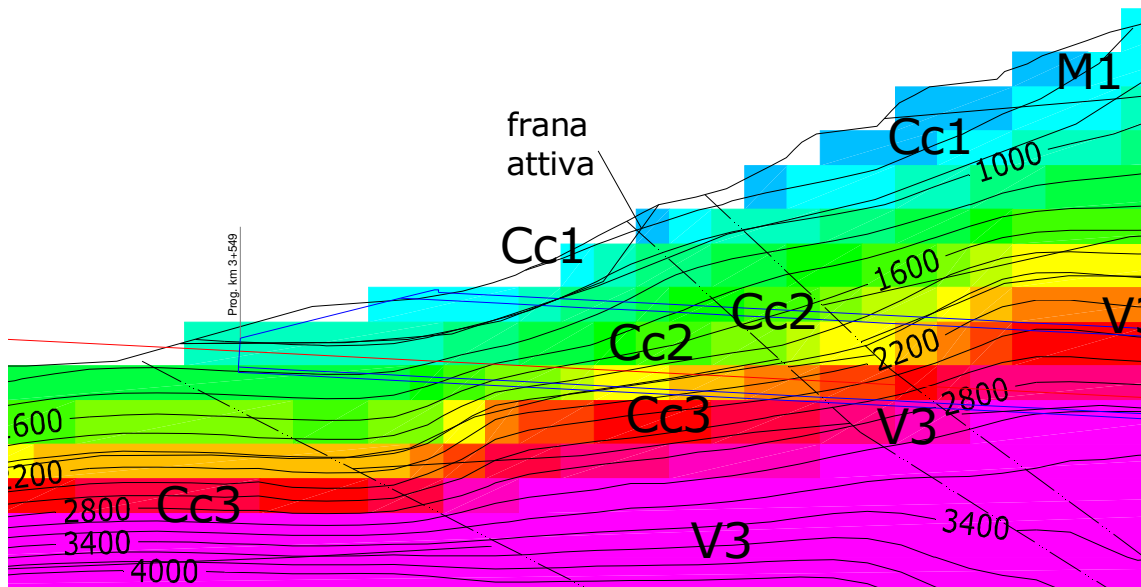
Particolare dell'imbocco Galleria Fornaci 1 (tav.9)
